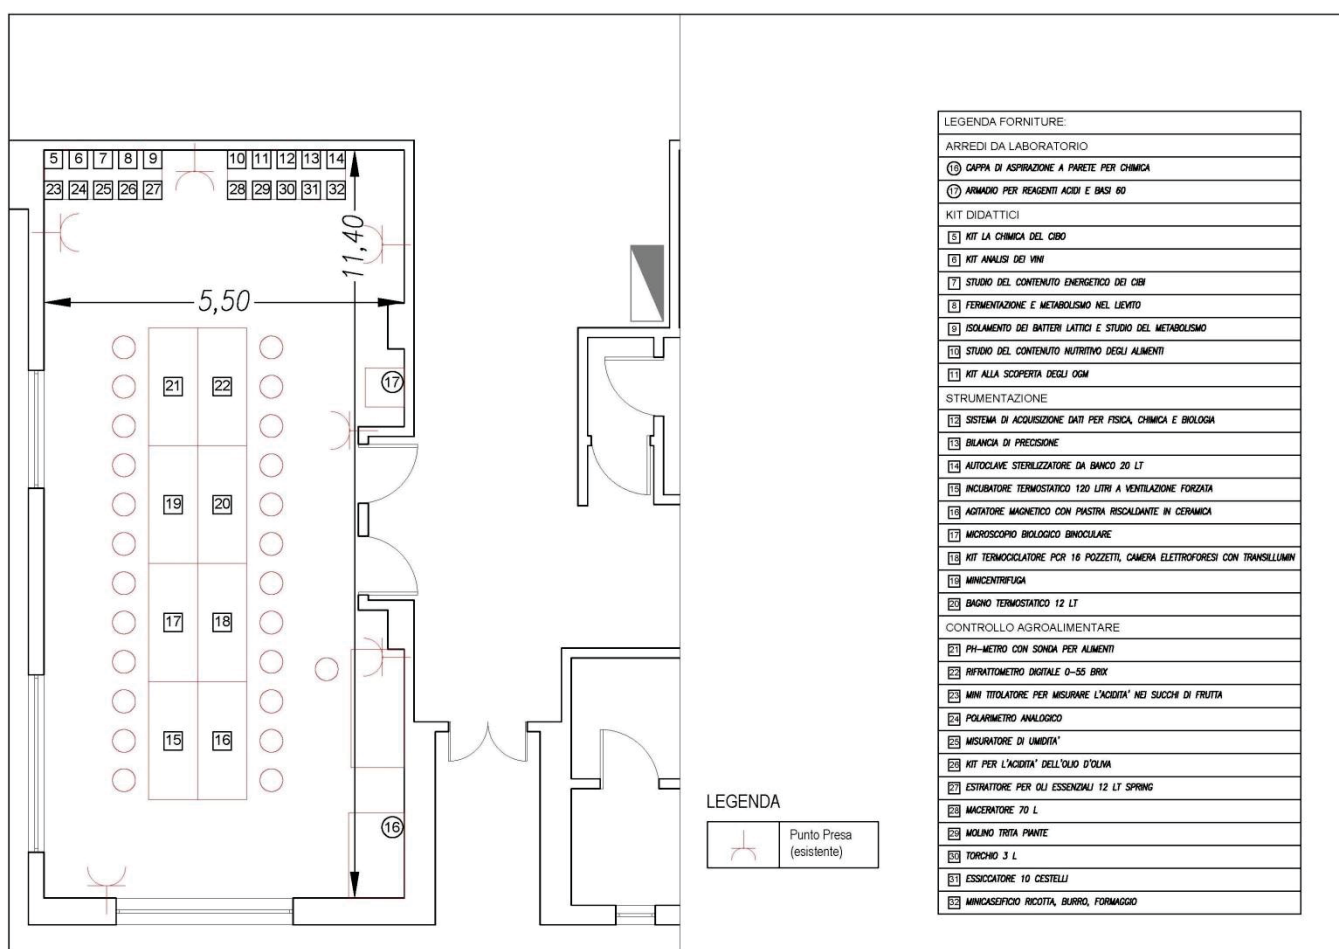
Pianta piano terra del laboratorio nel Fabbricato B - Stato di progetto
